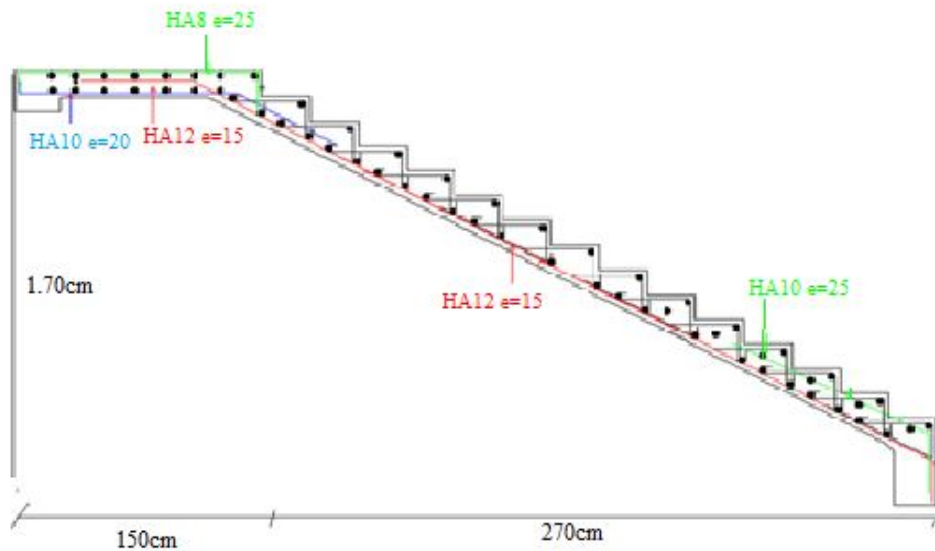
Schéma de ferrailage des escaliers type 1et 3.
